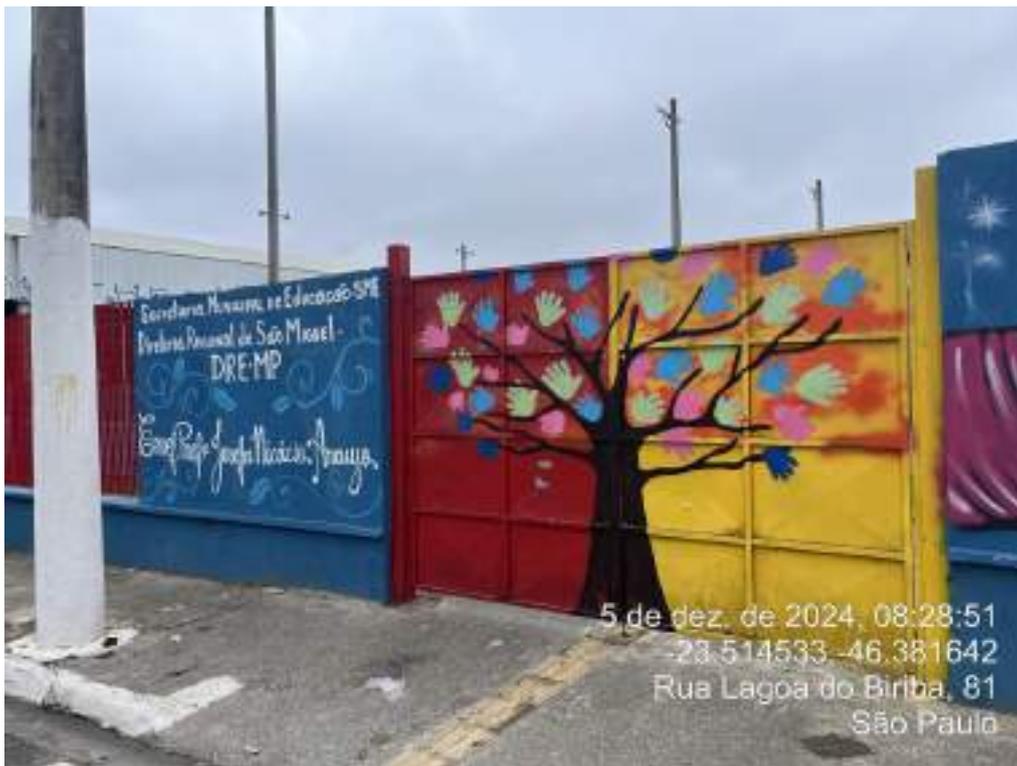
Vista da fachada da EMEF Prof.ª Josefa Nicácio Araujo.
